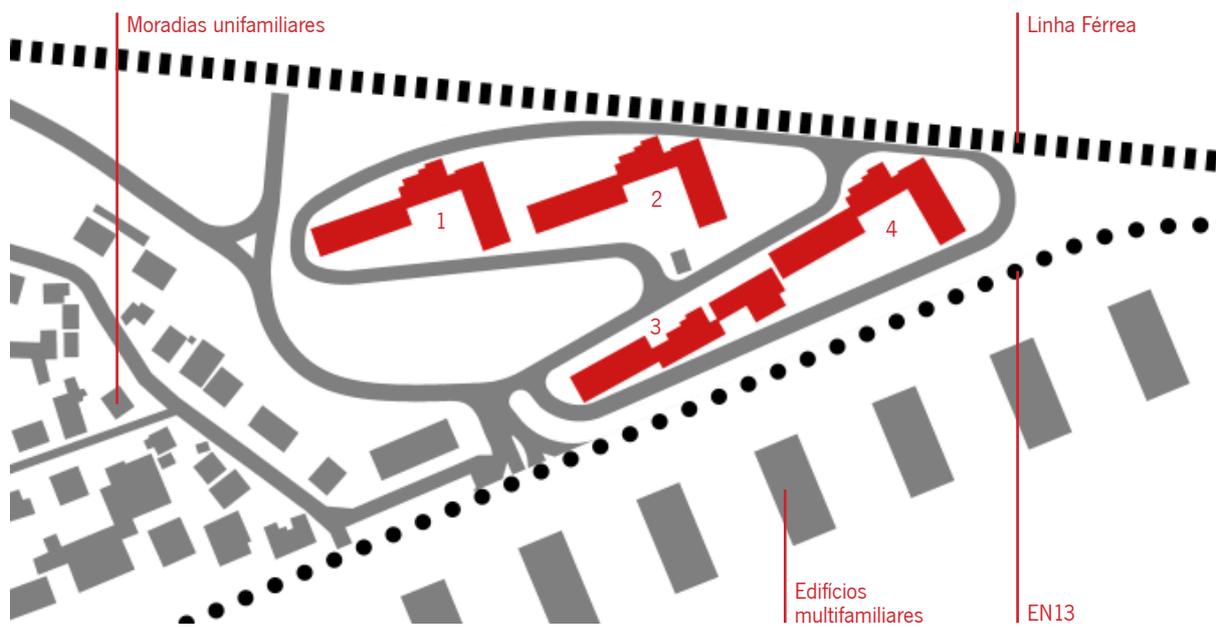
Planta de localização dos lotes do Bairro Social de Darque
